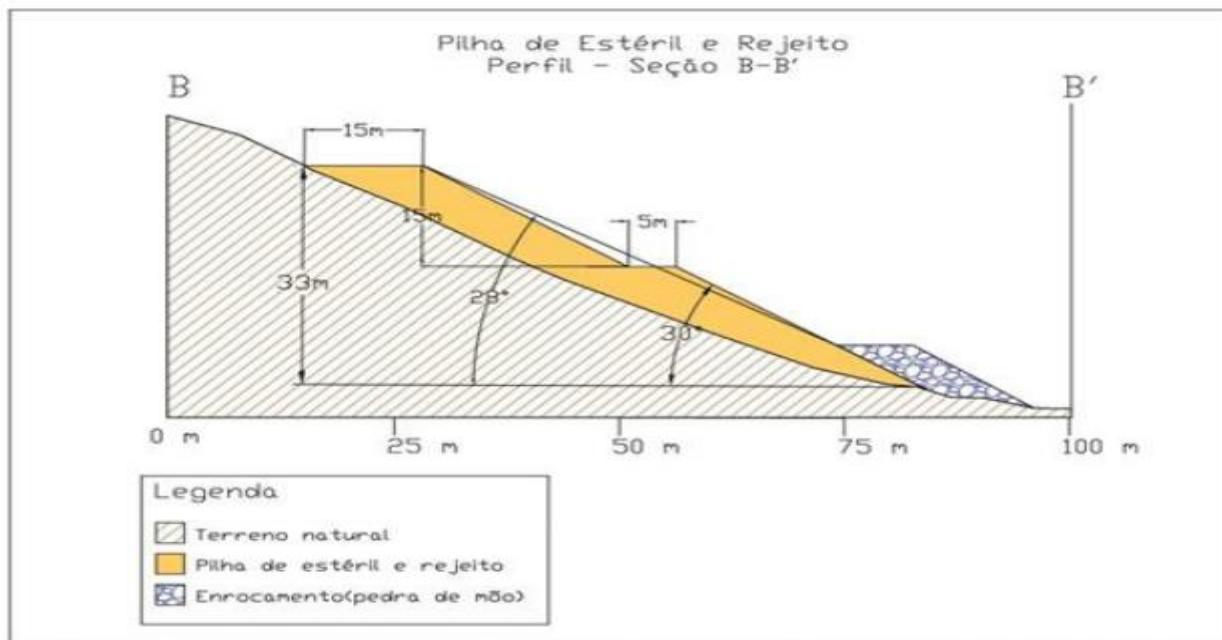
Perfil construtivo da pilha de estéril/rejeito 1, página 12, do Estudo de Alternativa Técnica e Locacional
